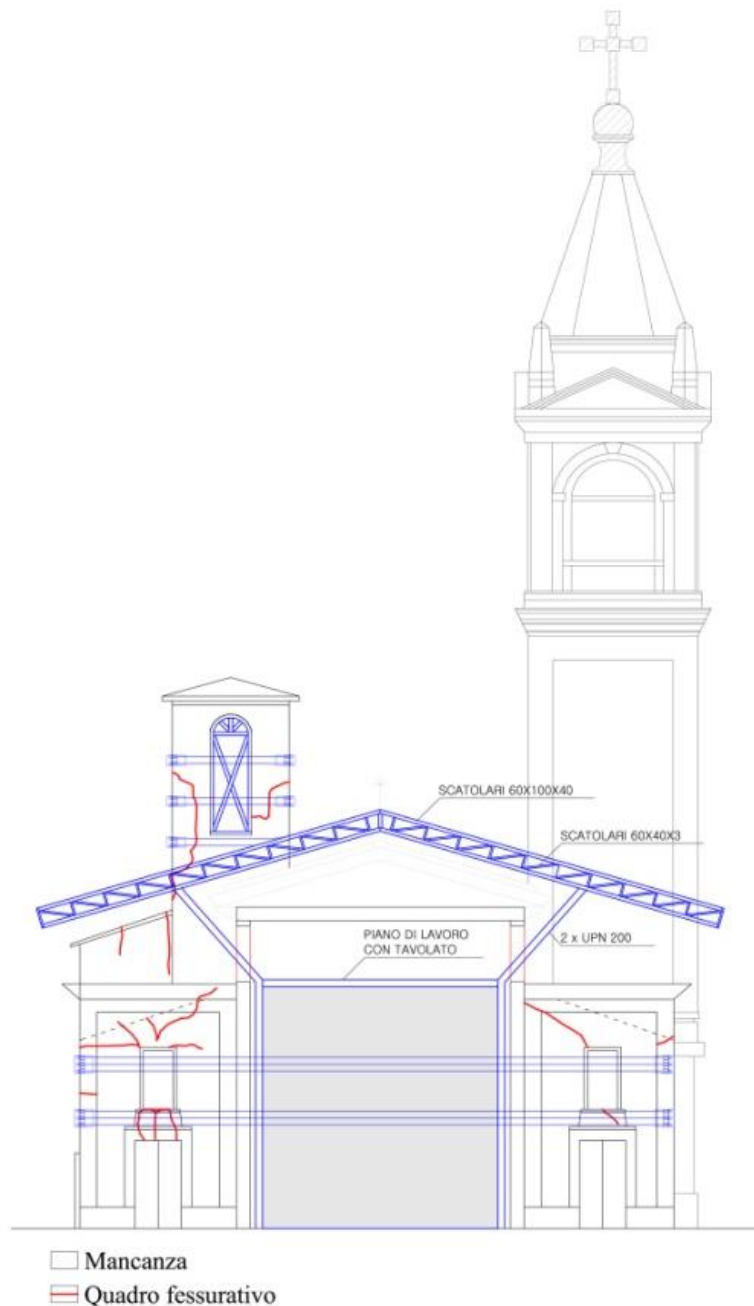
Sezione schematica dell'intervento sul prospetto principale
